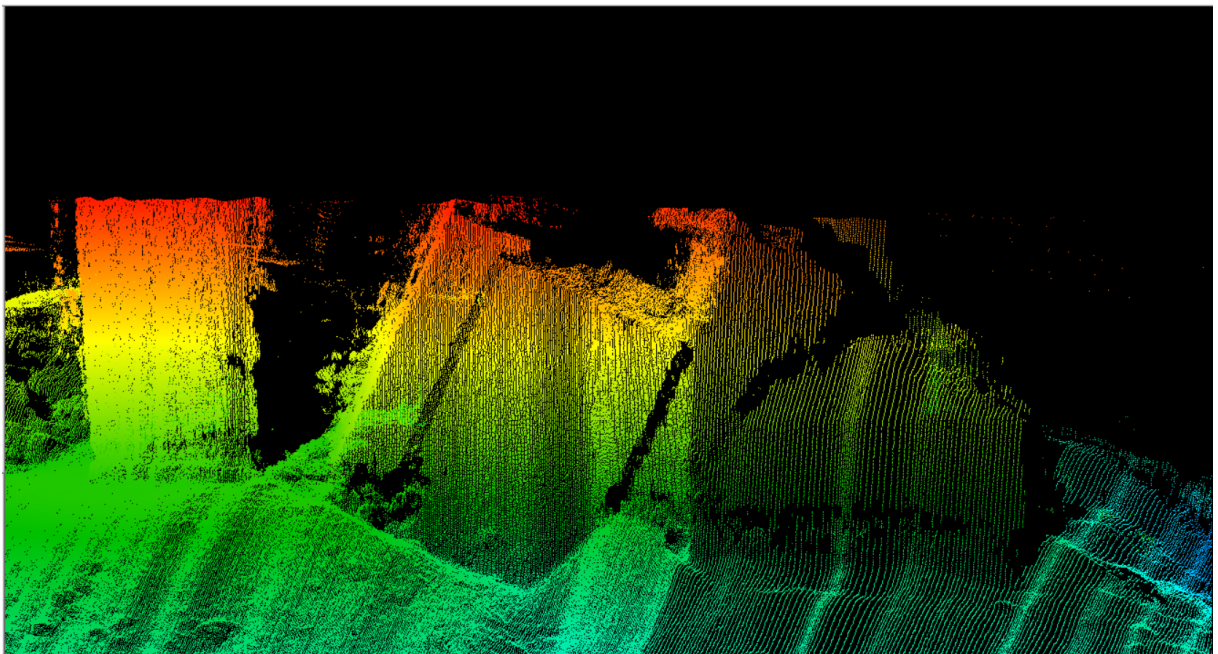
Bloques y superestructura pila P6 colapsados junto a pila P9 (izquierda).
